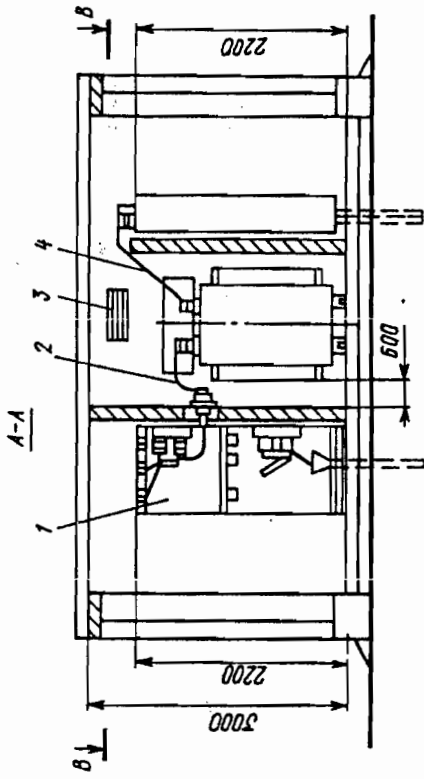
Габаритные, установочные и присоединительные размеры подстанции ЗТПС-10-1Т2К:
